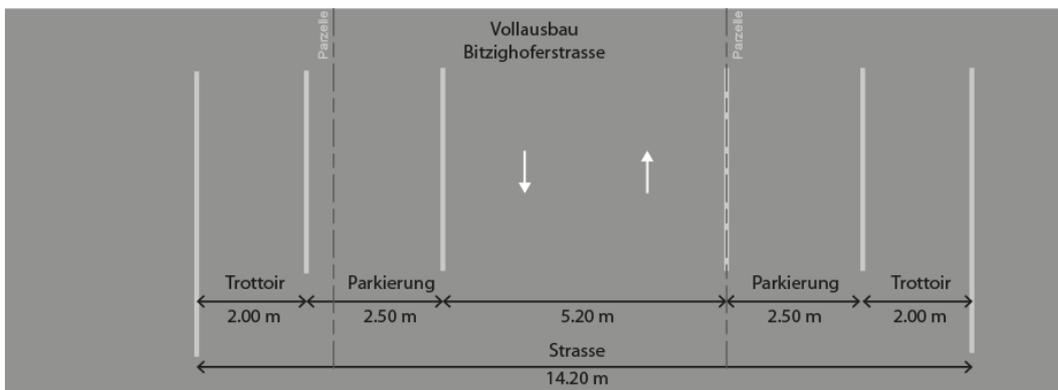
Musterquerschnitt Vollausbau einer Sammelstrasse mit beidseitiger Längsparkierung und Trottoir
